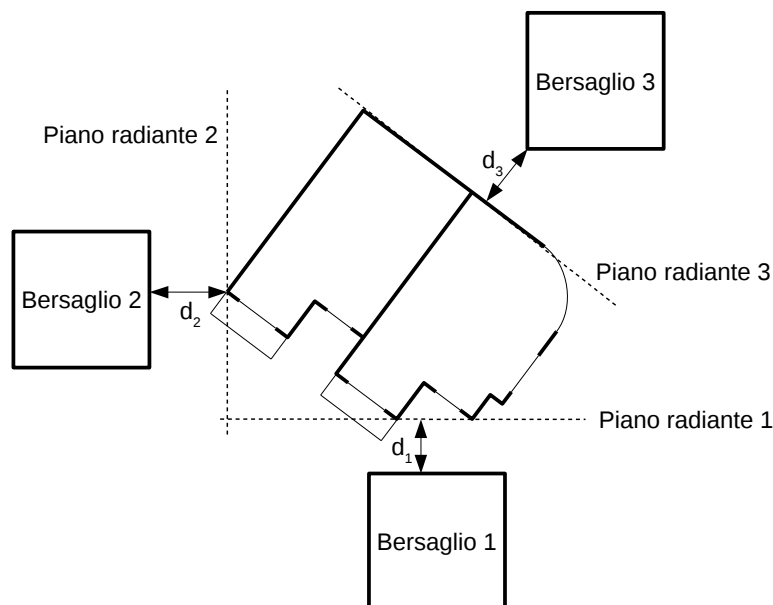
Determinazione del piano radiante (vista in pianta delle costruzioni)
